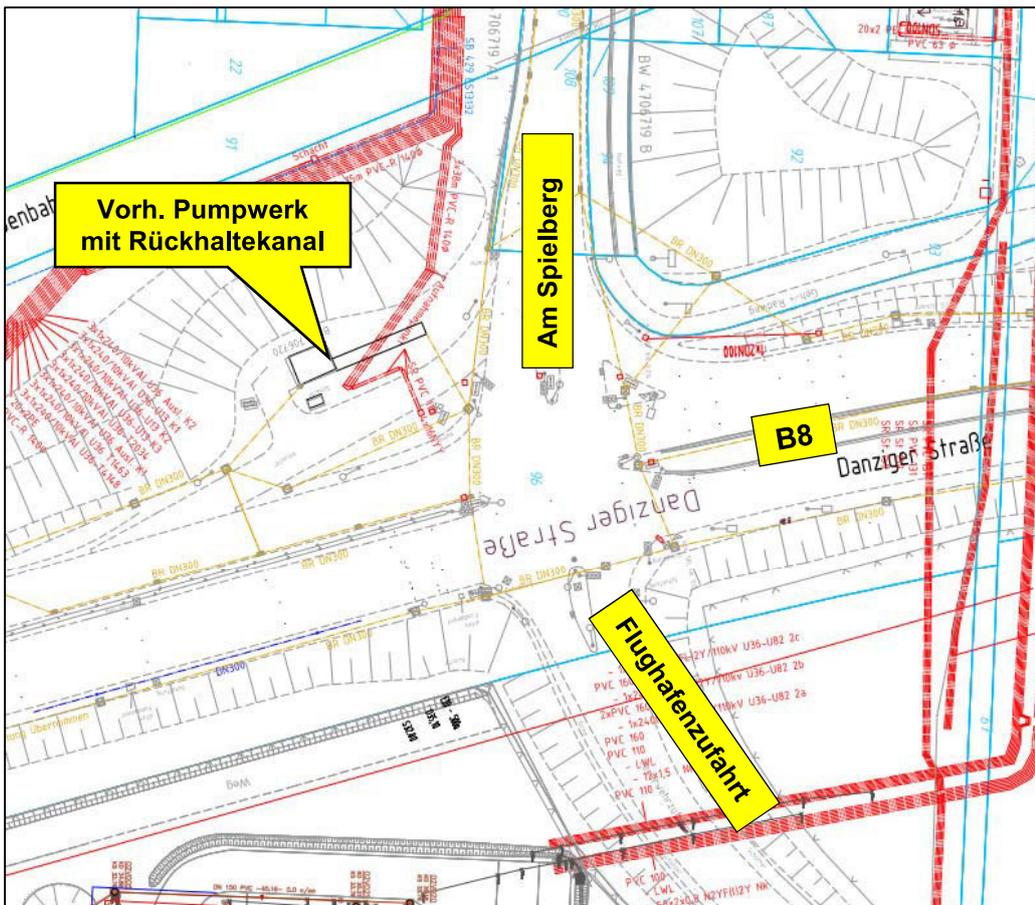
Lageplanausschnitt Bestand - Vorhandene Entwässerung
